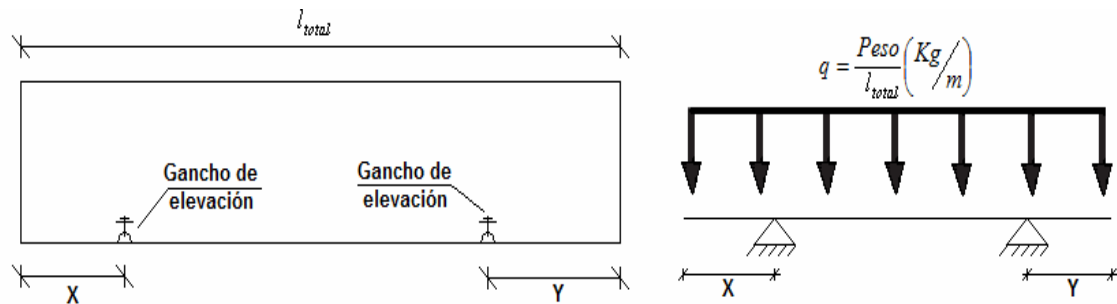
Ganchos elevación y acción peso propio en manipulación paneles
